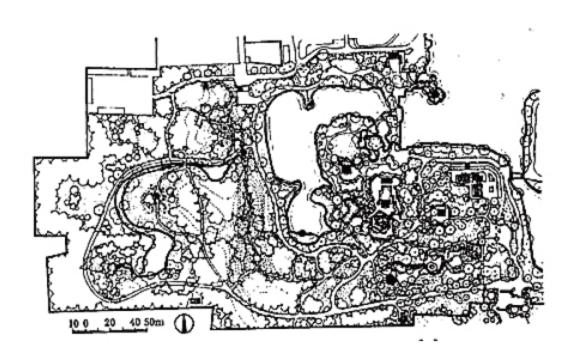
上海鲁迅公园总平面图 图 3.73 上海中山公园平面图
